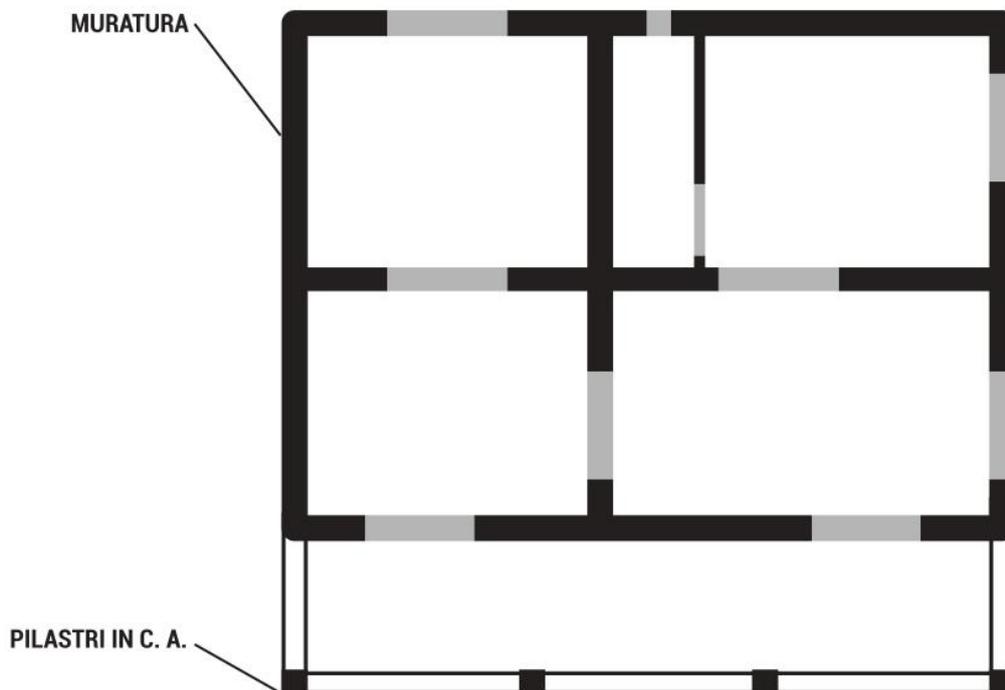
Esempio di struttura mista con muratura perimetrale e pilastri esterni [14]
